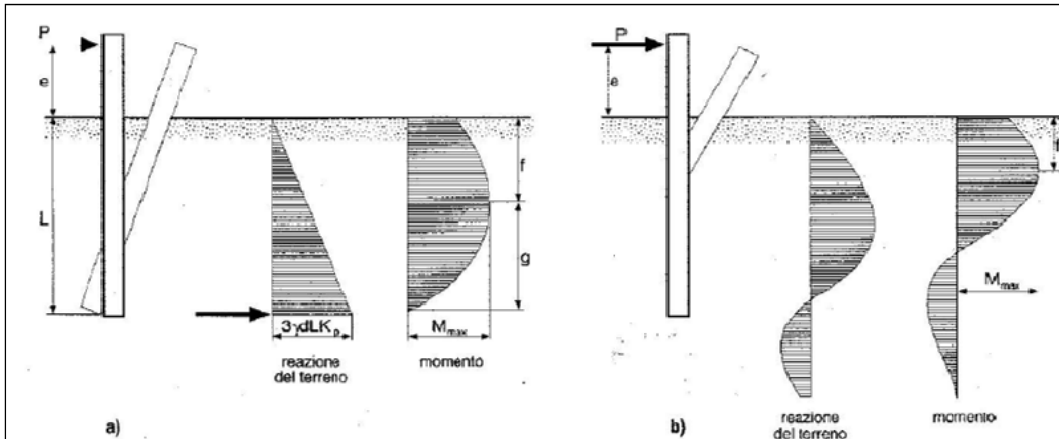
schematizzazione dell'azione del terreno su un palo infisso secondo Broms.
